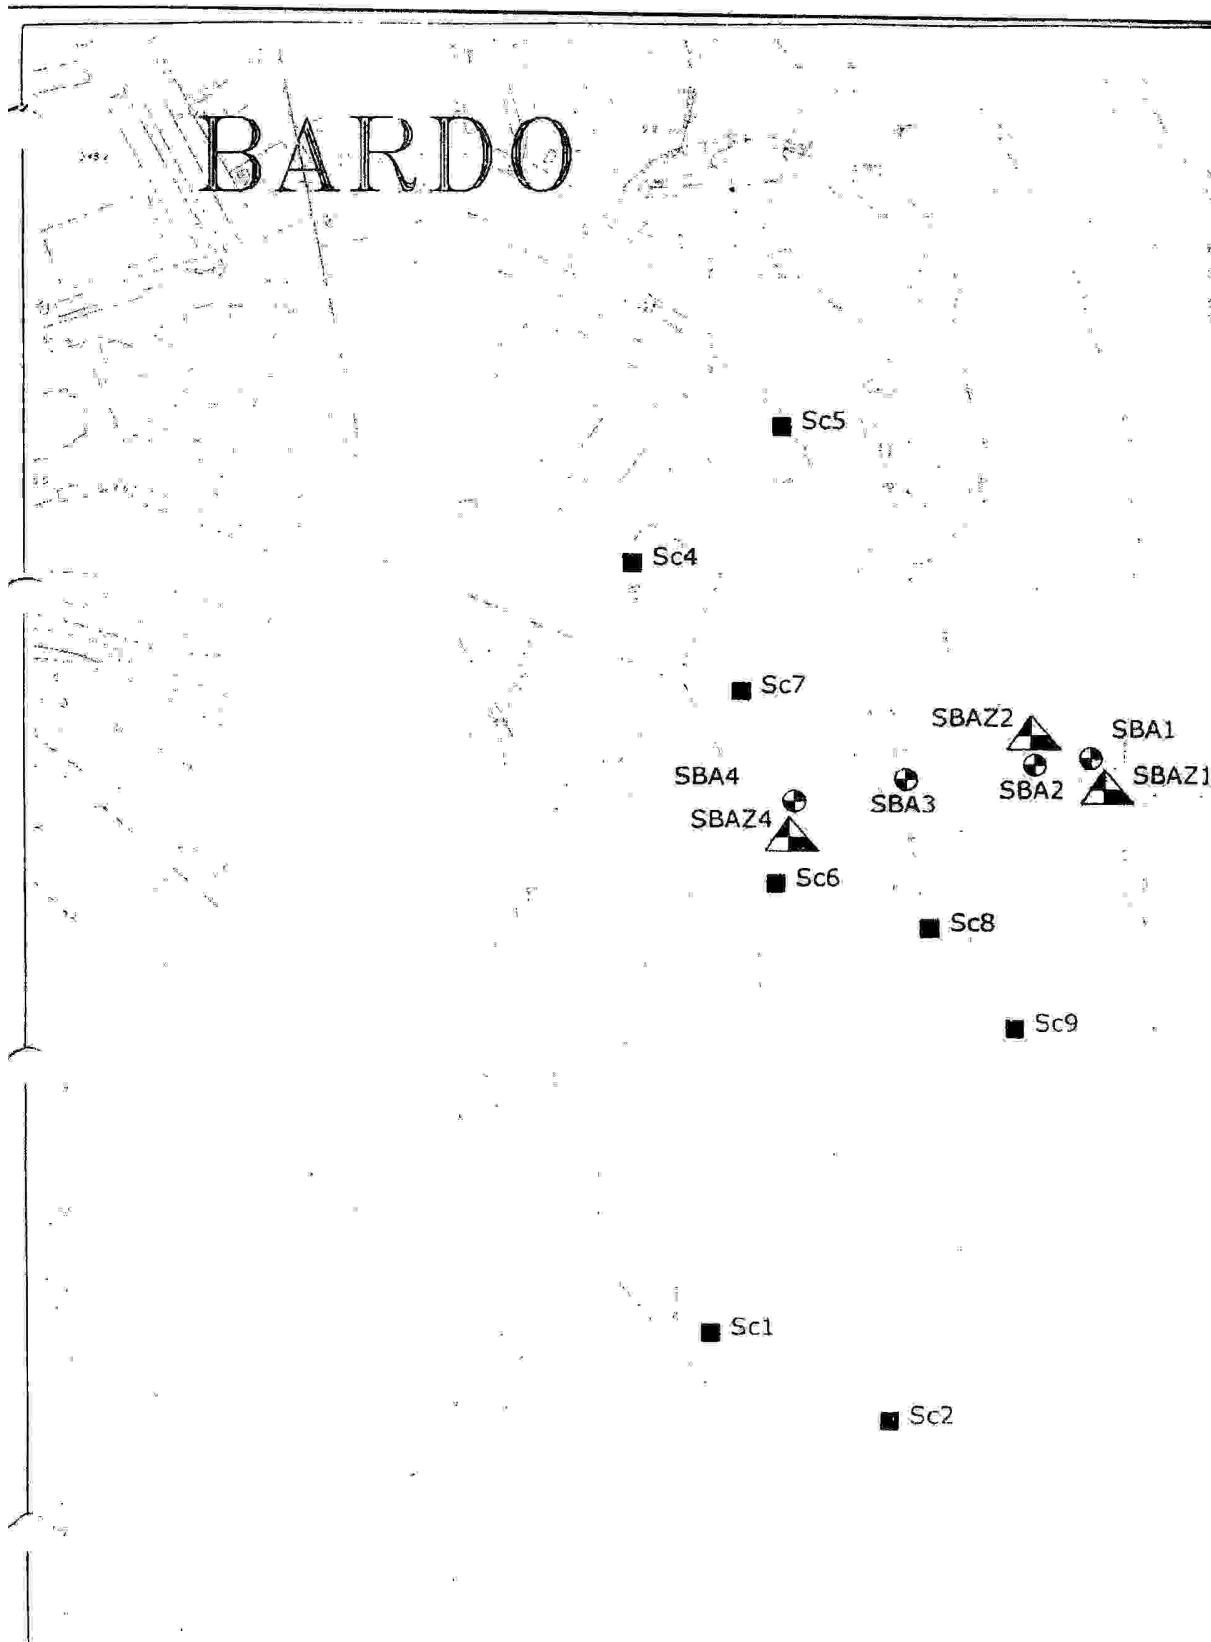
Plan de Recollement des Sondages : Site de Bardo.
